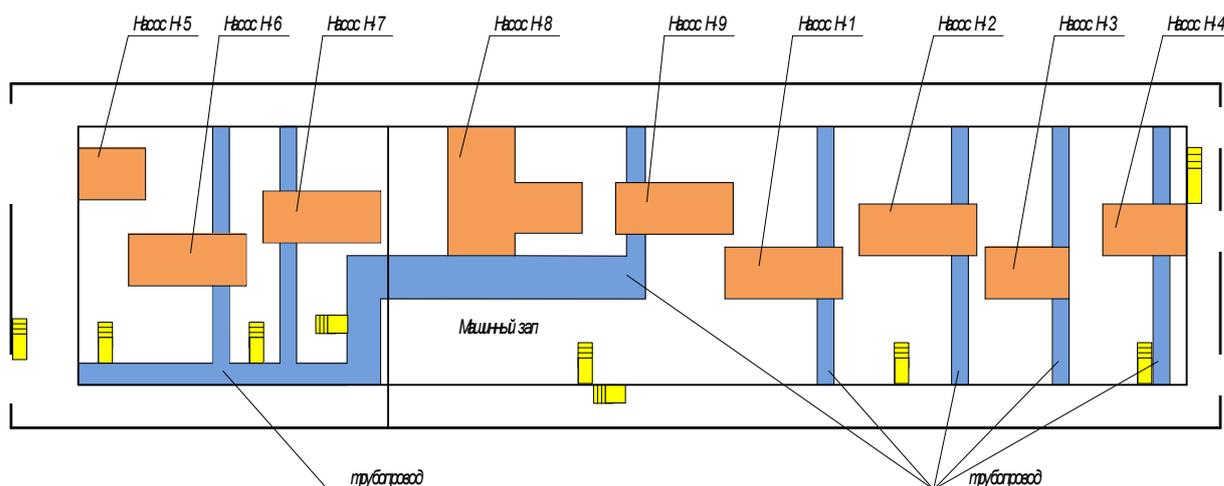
Схема расположения насосного оборудования и трубопроводов на площадке ВОЦ-I
